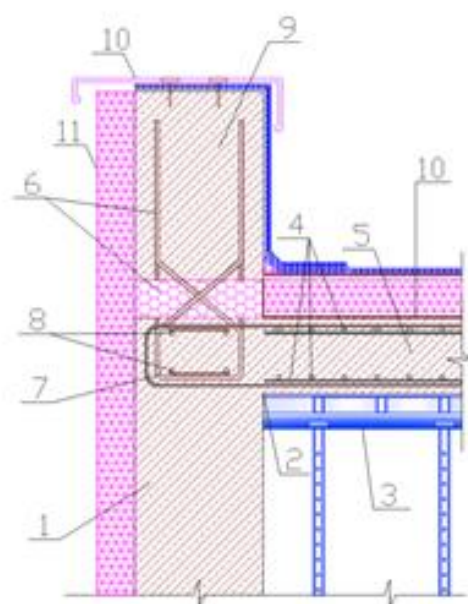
Схемы образования и ликвидации «мостиков» холода в местах сопряжения плиты покрытия и стеновой системы: 1- наружная стена; 2- нижняя отметка плиты перекрытия; 3- опалубка плиты перекрытия; 4 –арматура плиты покрытия; 5 – плита покрытия; 6 - армированный теплоизоляционный элемент из пеностекла; 7 - арматурное кольцо теплоизоляционного элемента-вкладыша; 8 - арматура плиты покрытия; 9 - конструкция парапета; 10 - элементы кровельной конструкции; 11- скрепленная фасадная теплоизоляция
